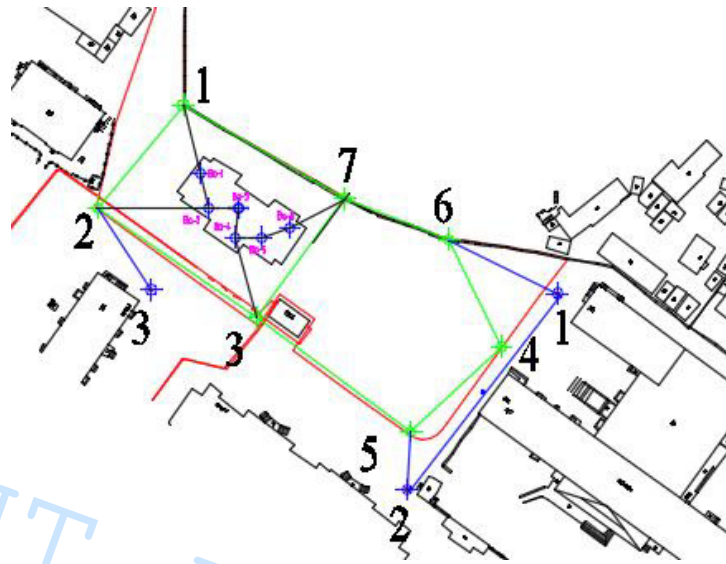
Внутрішня розпланувальна мережа будівлі
